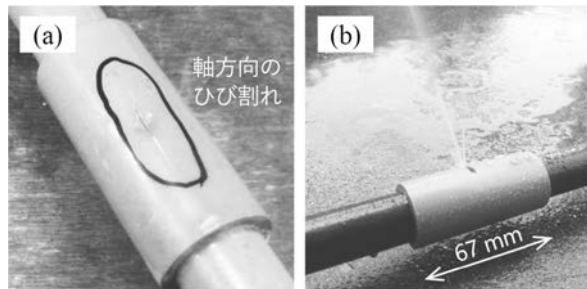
口径16mmの塩ビ管継手側面における (a) 実際のひび割れの例と (b) 模擬漏水
